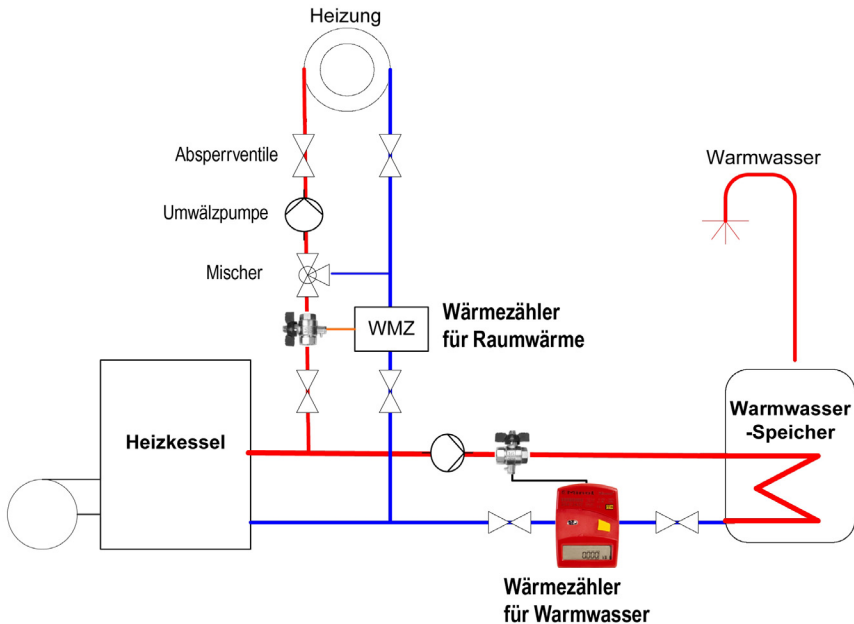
Prinzipskizze einer Heizanlage mit nebengestelltem Warmwasserbereiter. In diesem Fall dürfte der Einbau eines Wärmehählers für Warmwasser technisch einfach möglich sein. Ideal ist der Einsatz eines zweiten Wärmehählers für Raumwärme (§ 9 Abs. 2).
